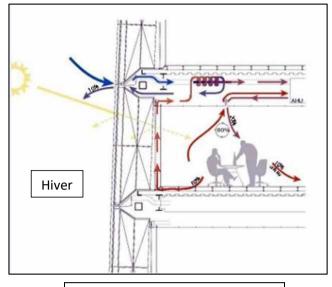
plan montrant la ventilation www.fosterandpartners.com
